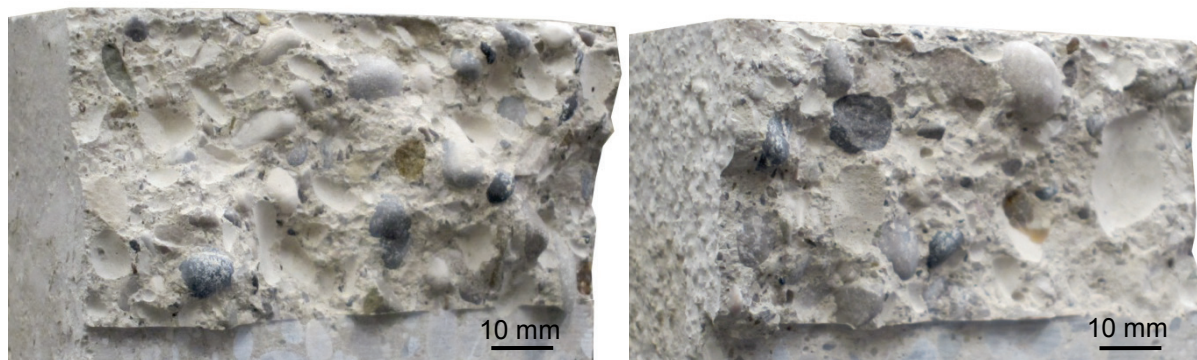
Typische Bruchflächen nach Wasser- (li.) und nach Trockenlagerung (re.)
